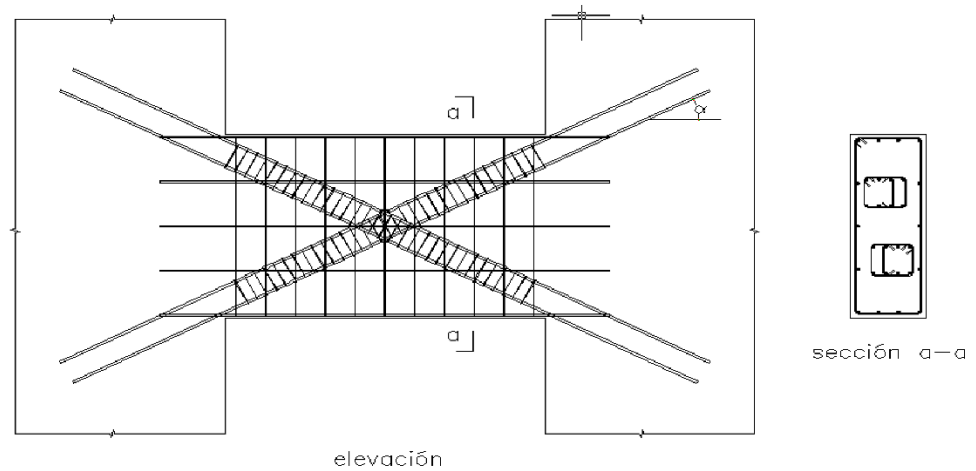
i Refuerzo de vigas de acople
